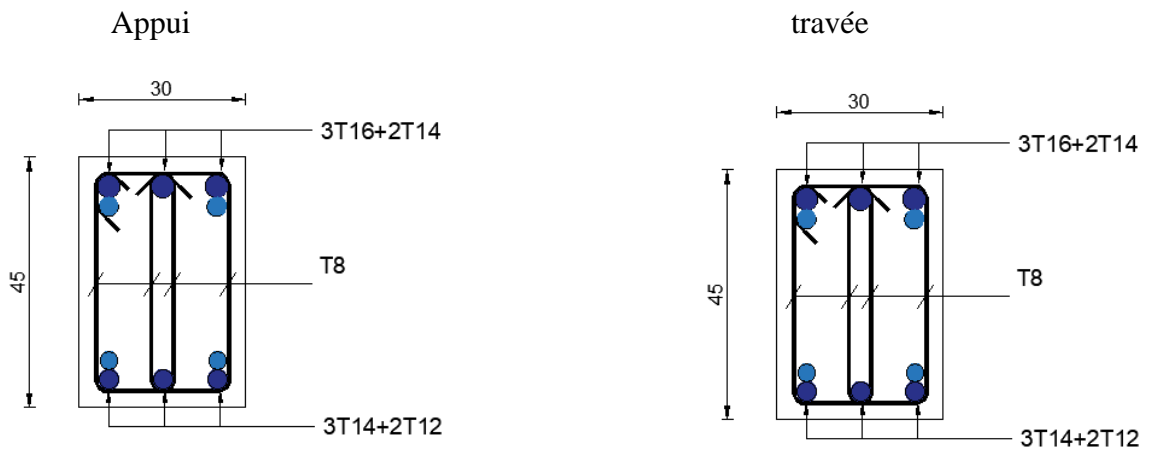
schéma de ferraillages des poutres secondaire (8^{ème} étage---RDC)
